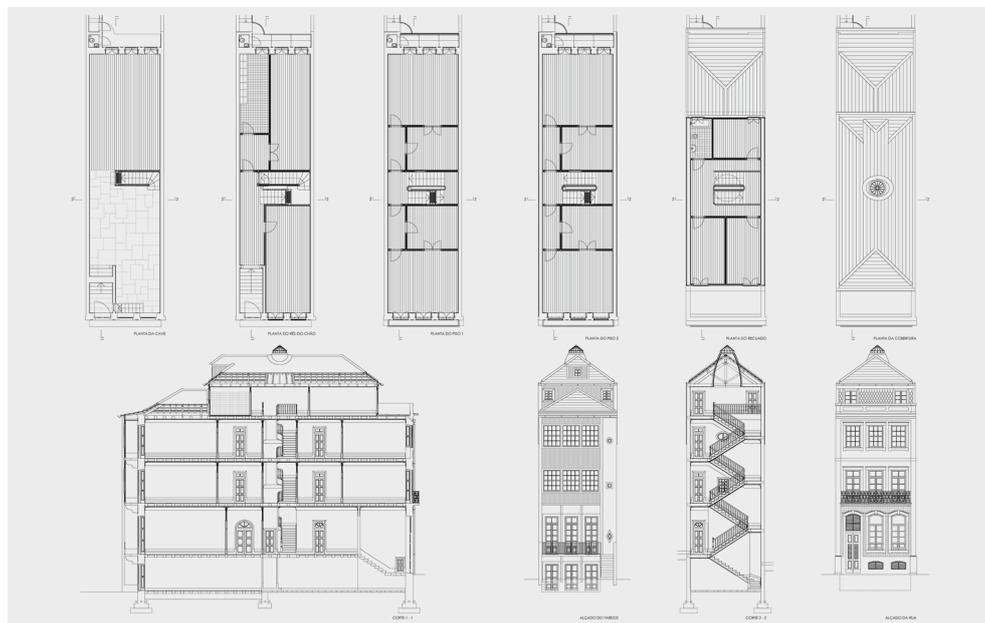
Plantas, cortes e alçados do modelo construtivo de uma casa burguesa do Porto [3].
